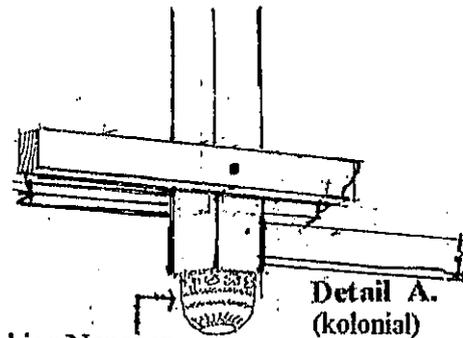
Sketsa detail kuda-kuda ruang Pracimayasa. (Detail K). (kolonial)
